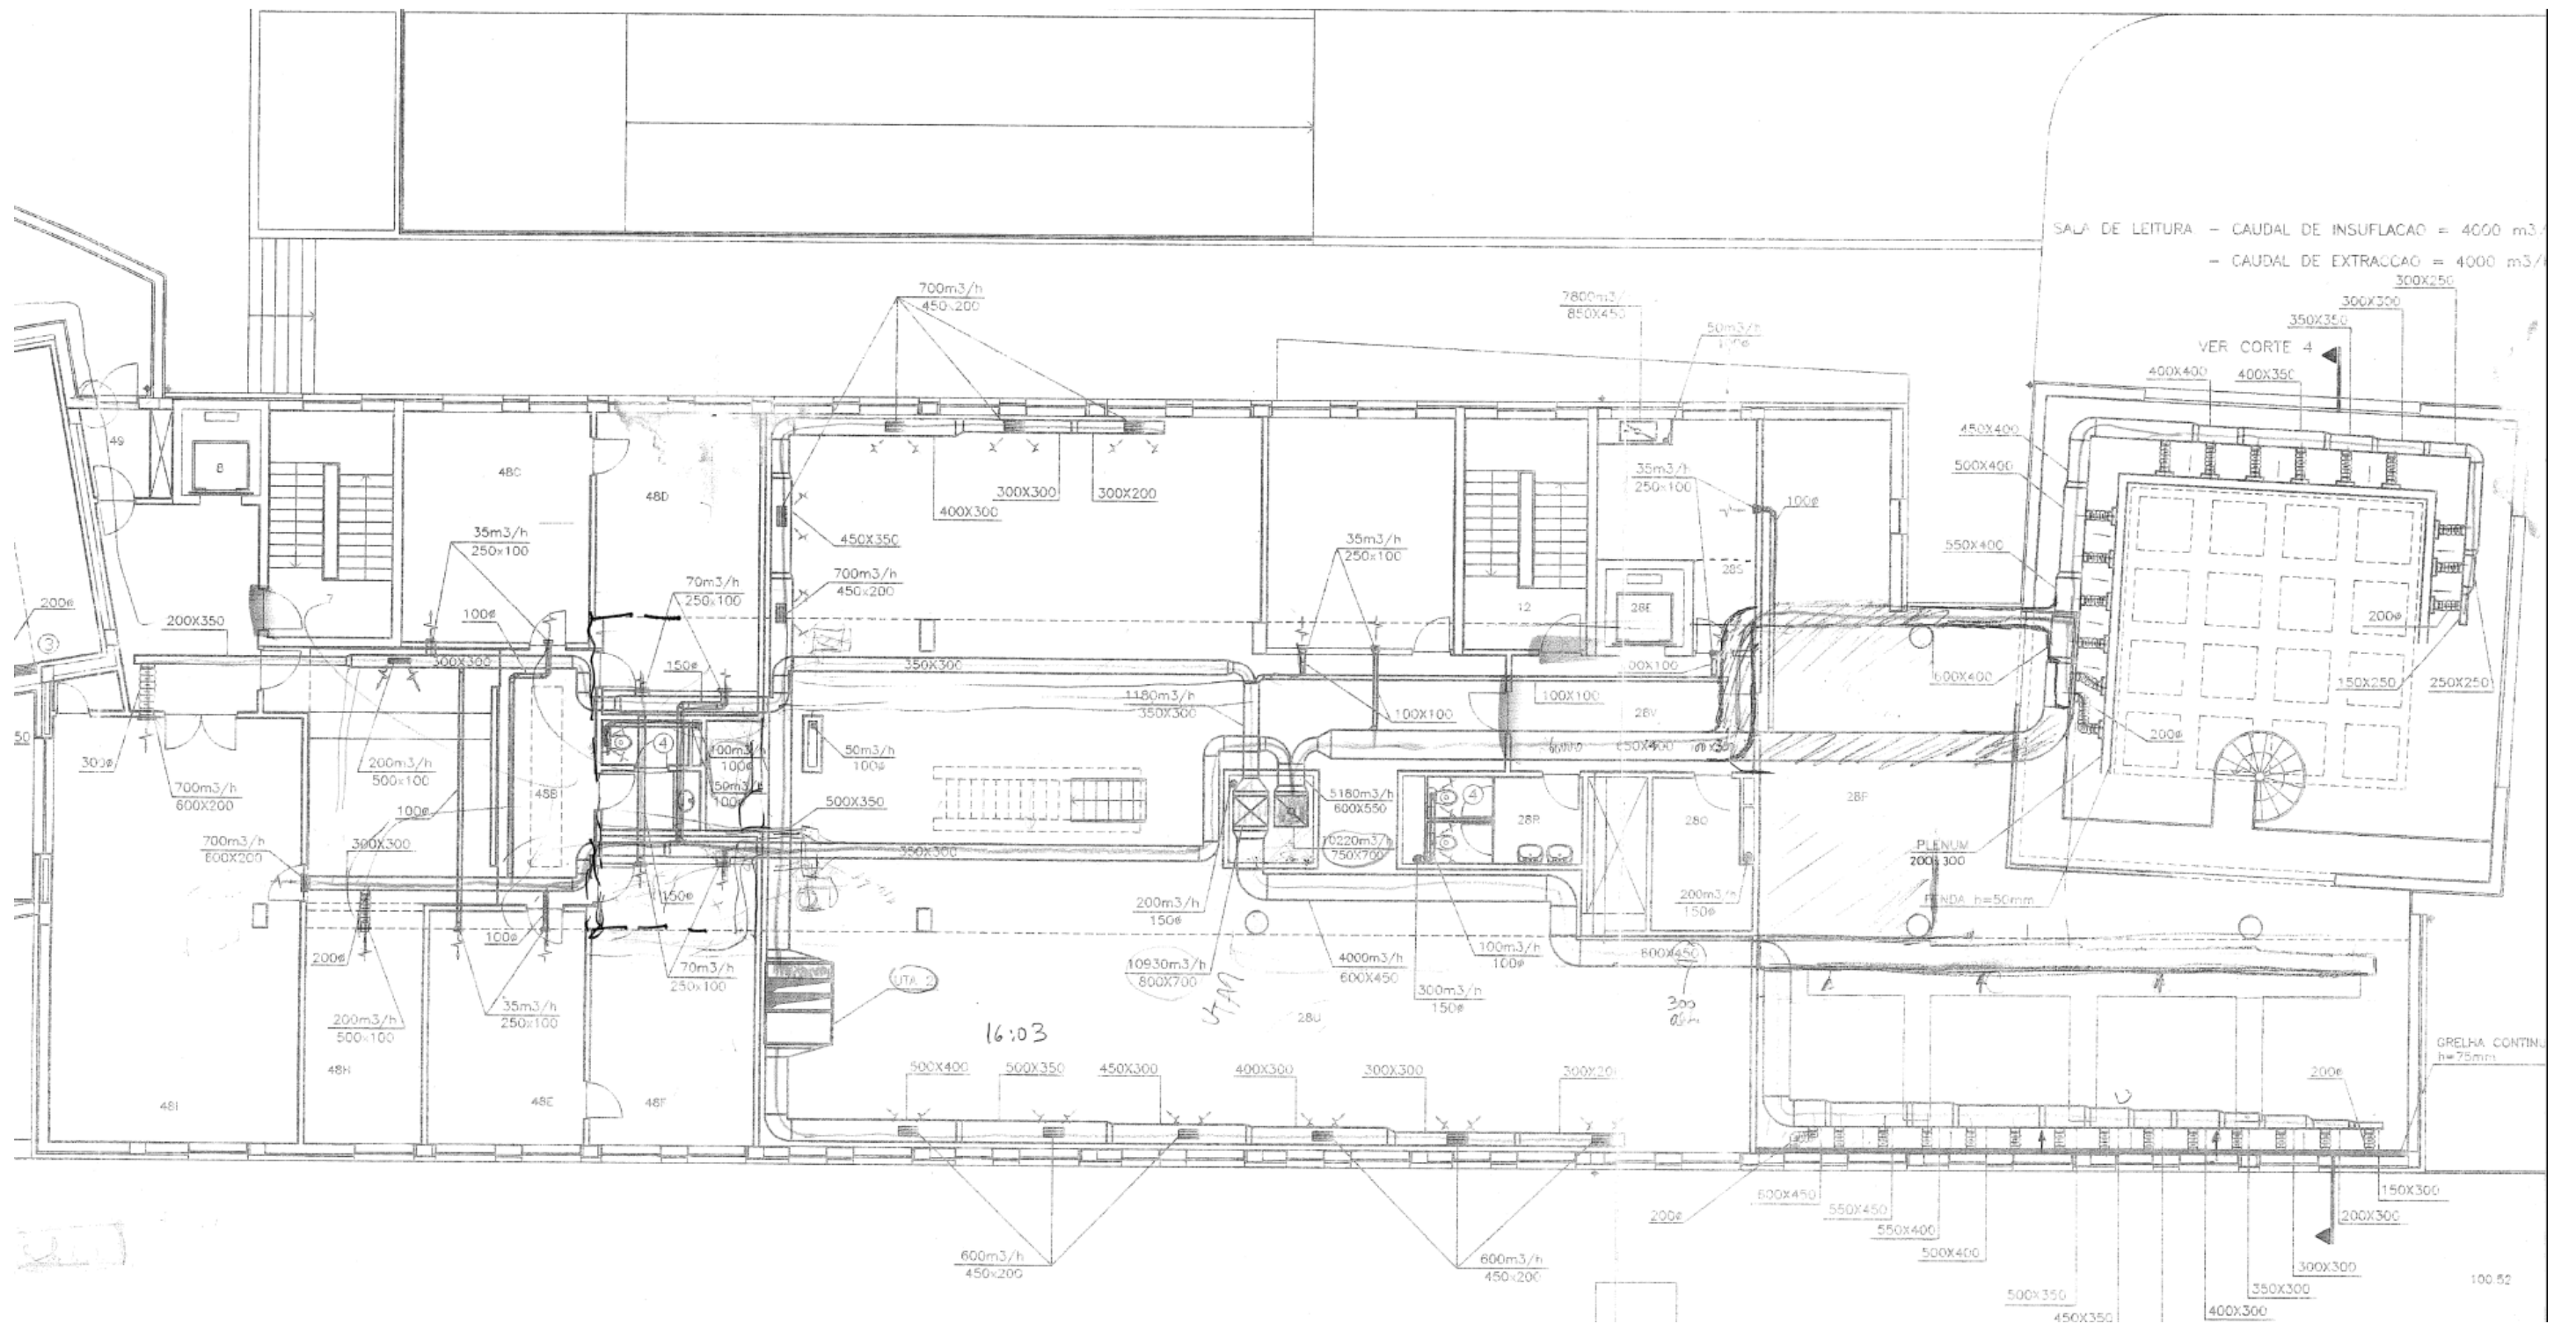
Planta da rede de condutas - Piso 3 (parte)
